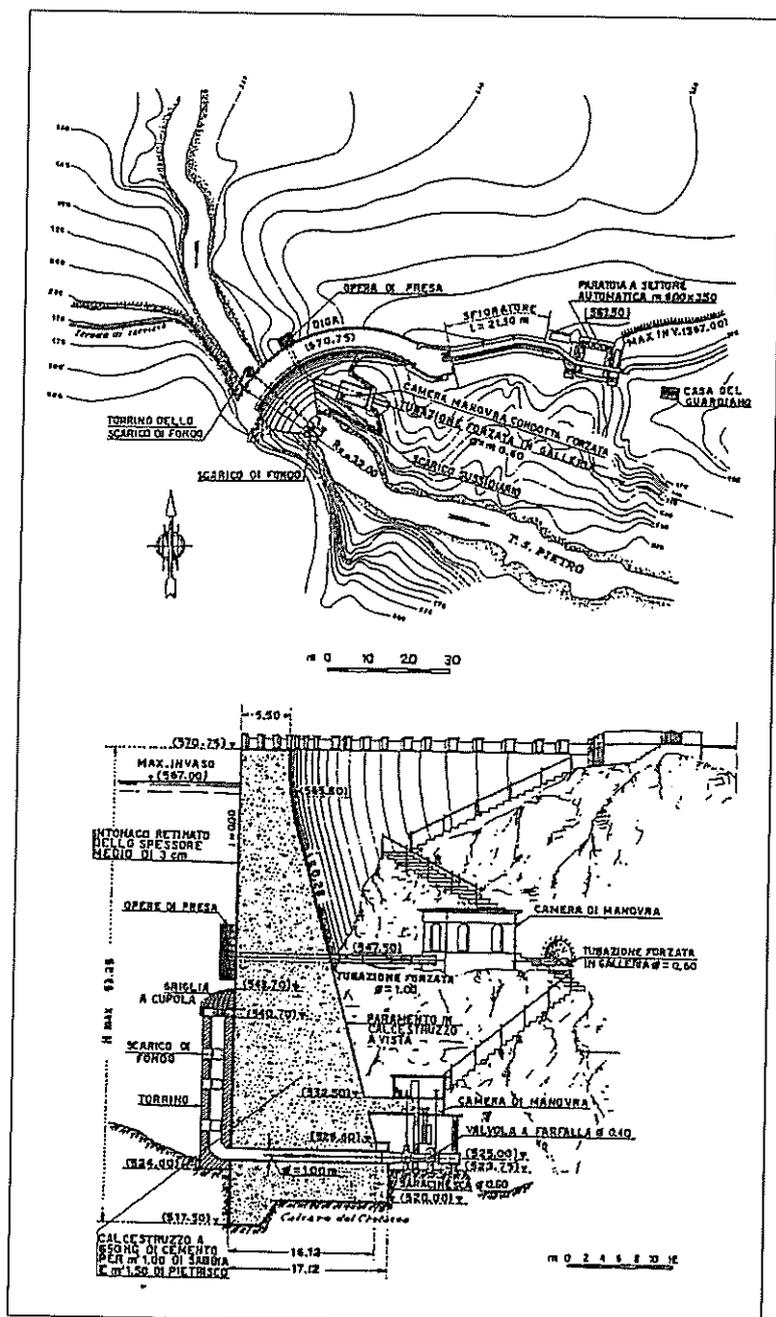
Diga di Muro Lucano: Planimetria - Sezione tipo.
